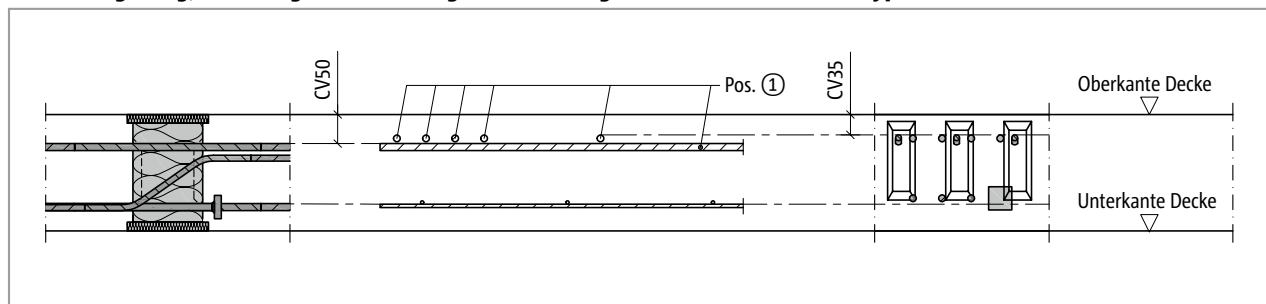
Schöck Isokorb® XT Typ C: Bauseitige Bewehrung Außenecke (Schnitt XT Typ C-L-CV50, Ansicht XT Typ C-R-CV35)
